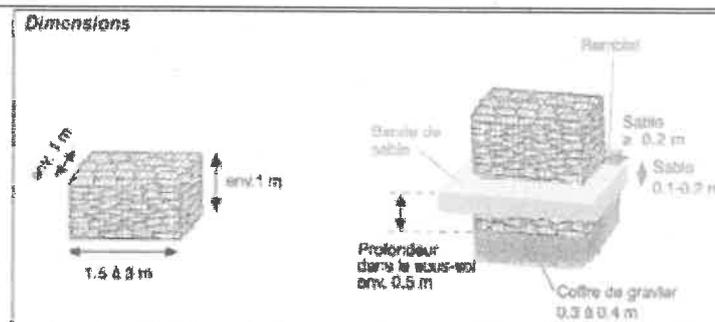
Mise en œuvre du gabion en faveur du Lézard des murailles
